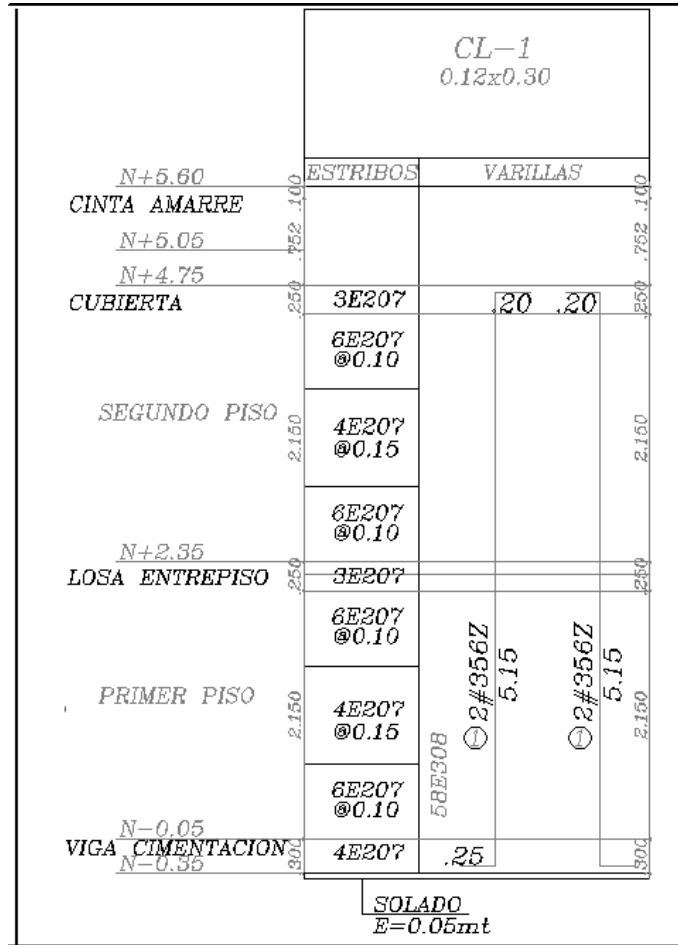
Diseño de Columnas- bajado de AutoCAD
